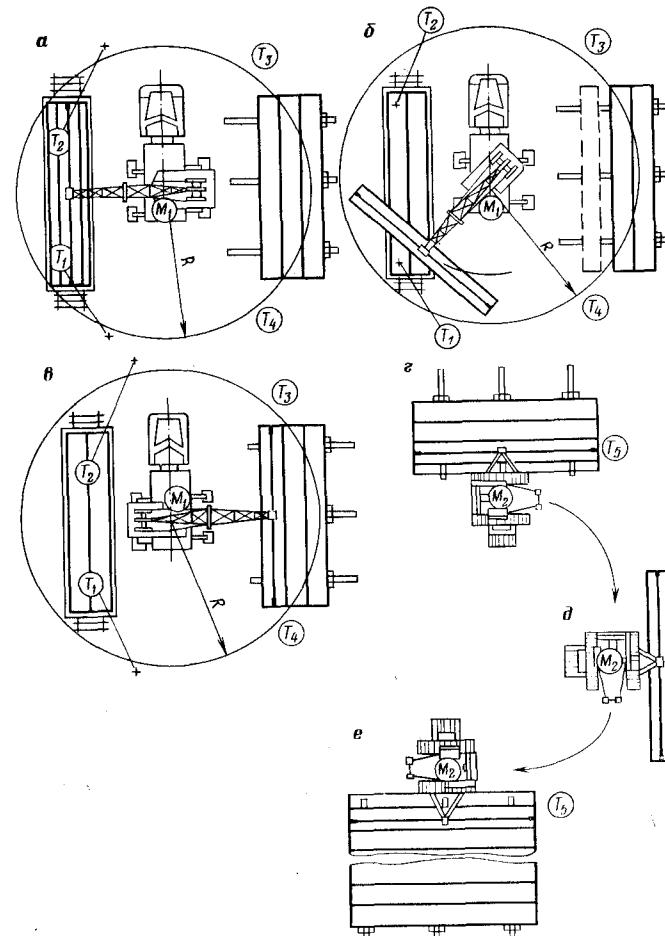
Схемы расстановки и перемещения рабочих при выгрузке труб из полувагонов с укладкой в штабель:
